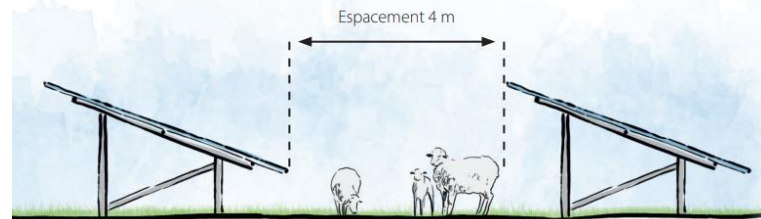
Schéma de coupe des trackers sur la zone sud ovin (Source : Composite)
